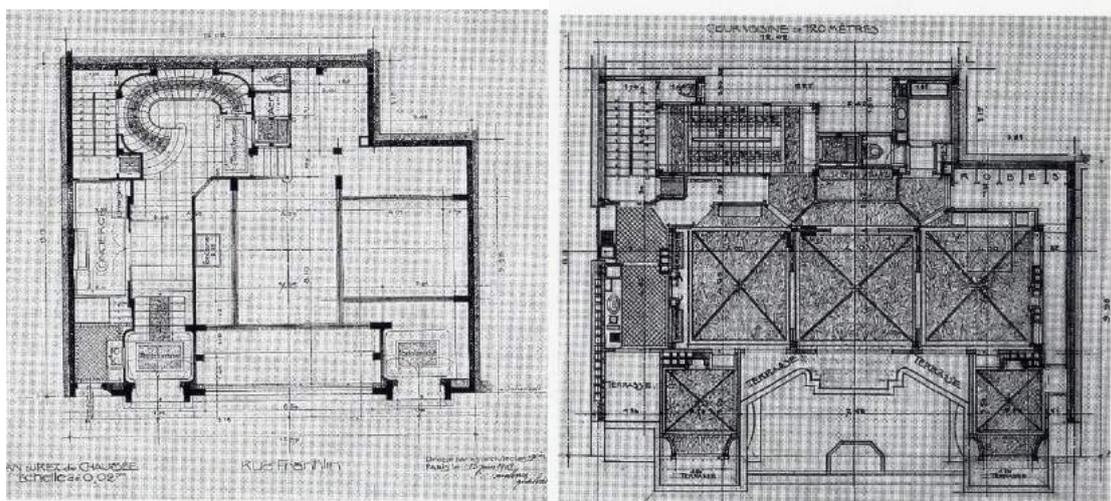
Planta baja y planta primera del inmueble de apartamentos del arquitecto A. Perret, rue Franklin. Paris, 1903. Fuente: (Culot, 2000)
